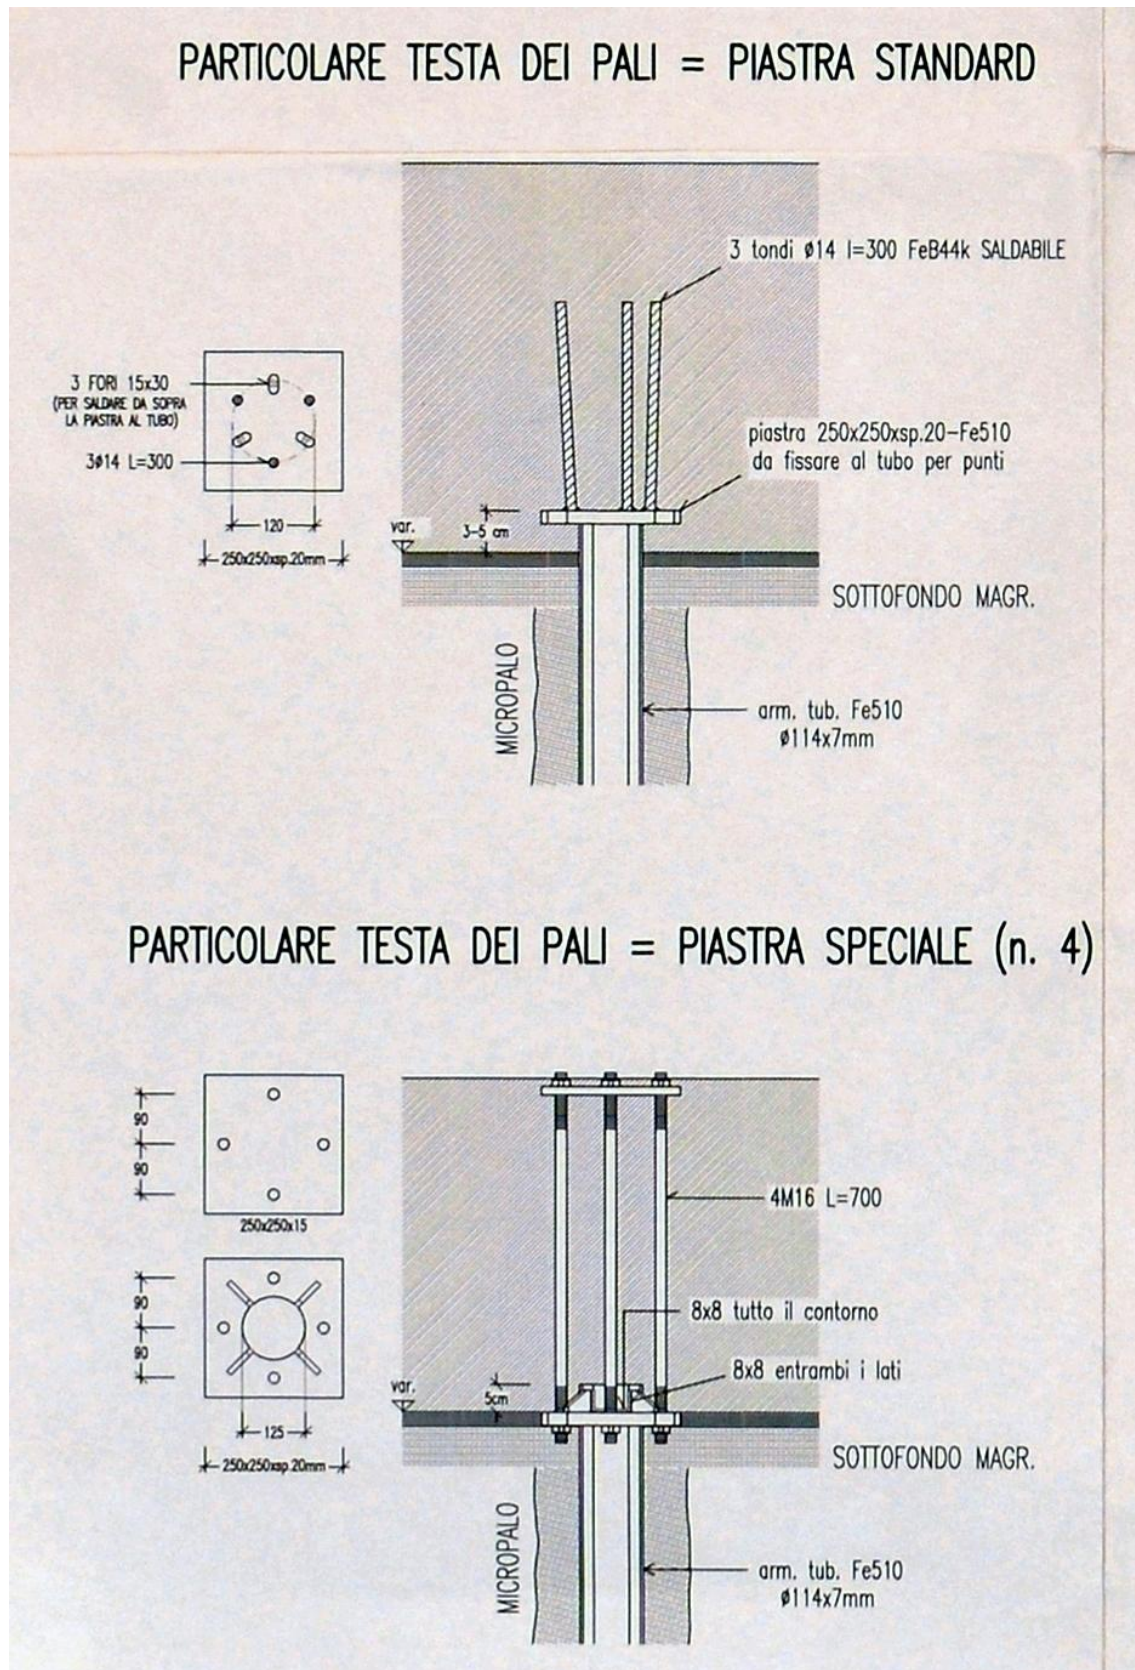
Particolare di A.2003.a.us.c.T01 - Pianta delle fondazioni - Particolari teste pali
